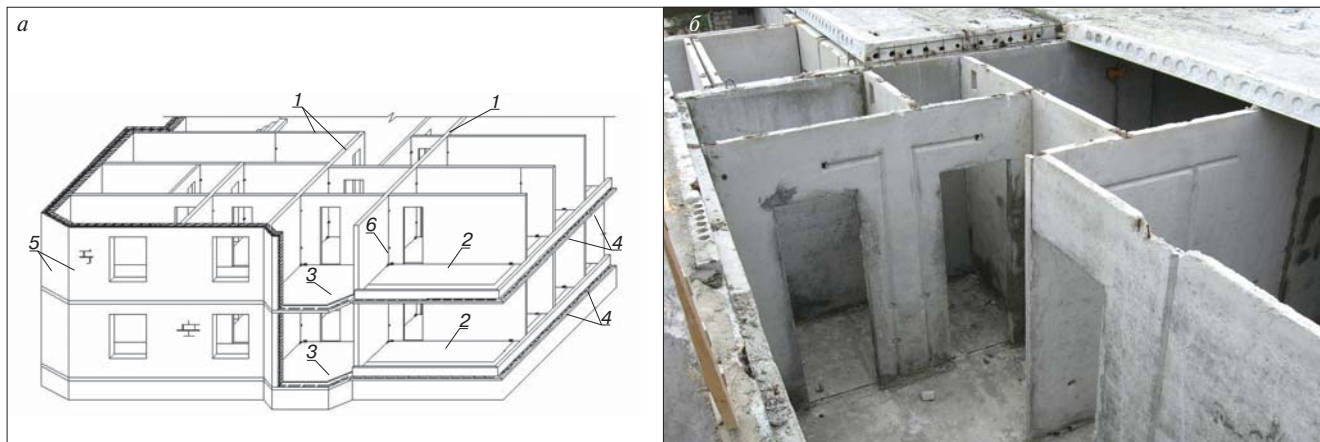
Фрагмент каркаса жилого дома: а – архитектурно-конструктивная система: 1 – внутренние продольные и поперечные стеновые панели; 2 – плиты перекрытий; 3 – плиты перекрытий с эркерами; 4 – перфорированная обвязочная L-образная балка; 5 – наружные теплоэффективные самонесущие стены на один этаж; б – узлы соединения стеновых панелей между собой; б – процесс возведения здания
